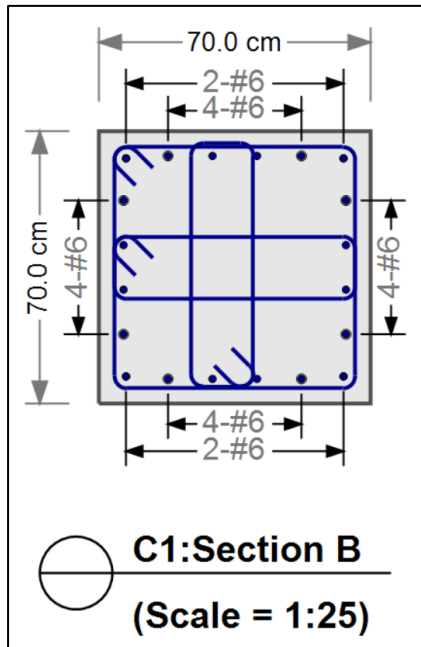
Detallado de acero en columnas típicas niveles 1-3
